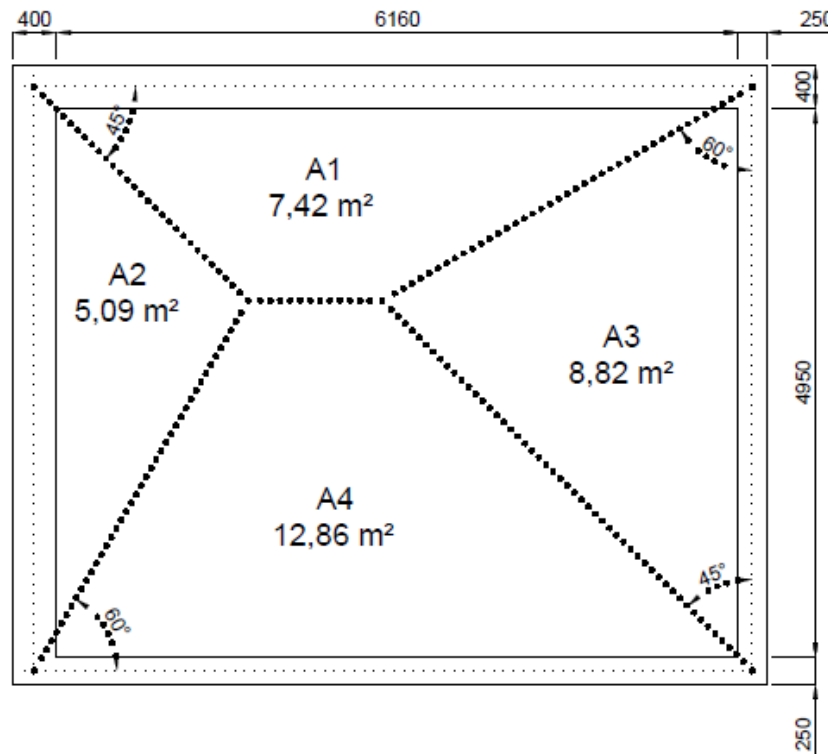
Distribuição de cargas na laje da Sala 19.
